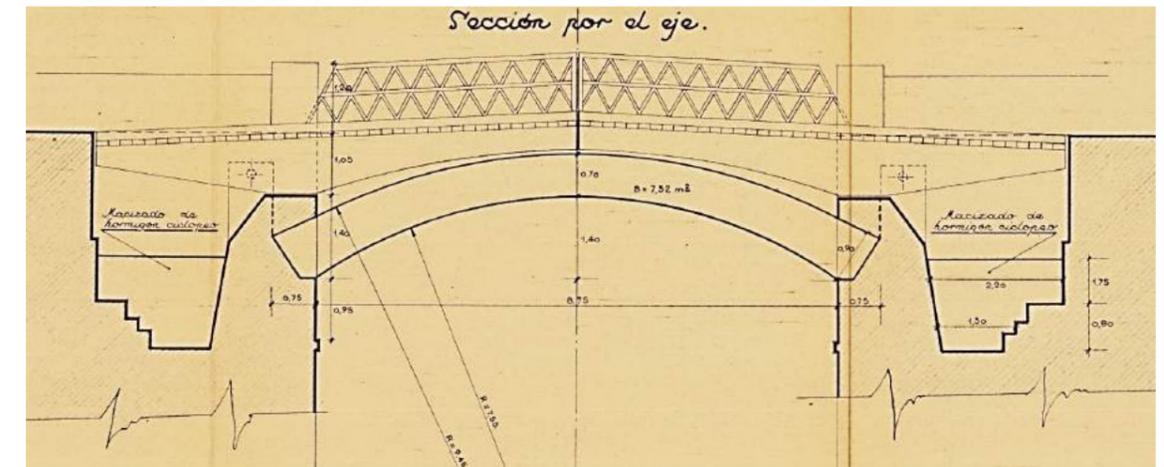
Plano alzado de aguas abajo del vano 4, durante la construcción de la bóveda de hormigón en masa, cuando todavía se encontraba colocado el tramo metálico
